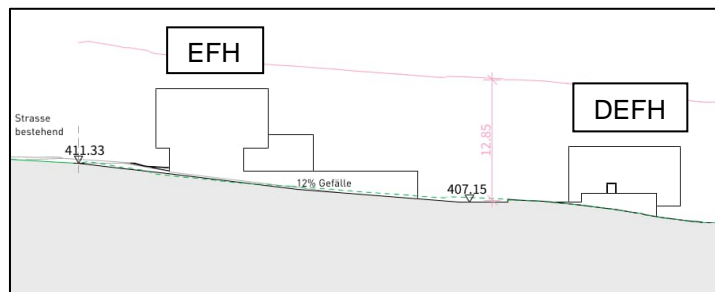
Ansicht Rampe mit EFH, DEFH
